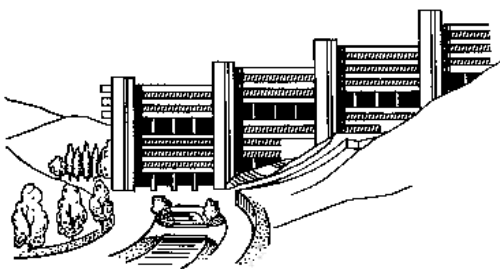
Пример ступенчатого дома на крутом склоне
